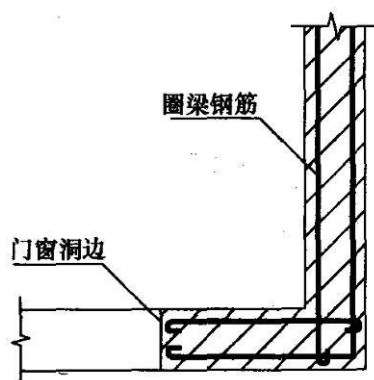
(a) 配筋砖圈梁在洞口边、转角处钢筋搭接做法示意图
